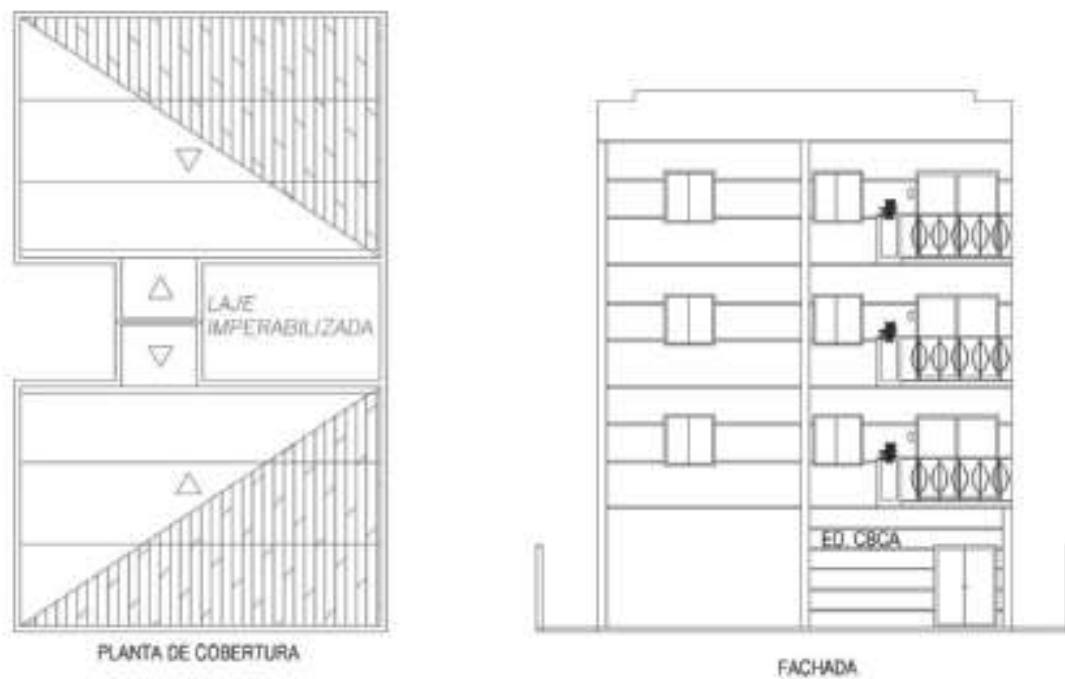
Planta de cobertura e fachada. Fonte: INSTITUTO AÇO BRASIL et al., 2011.
